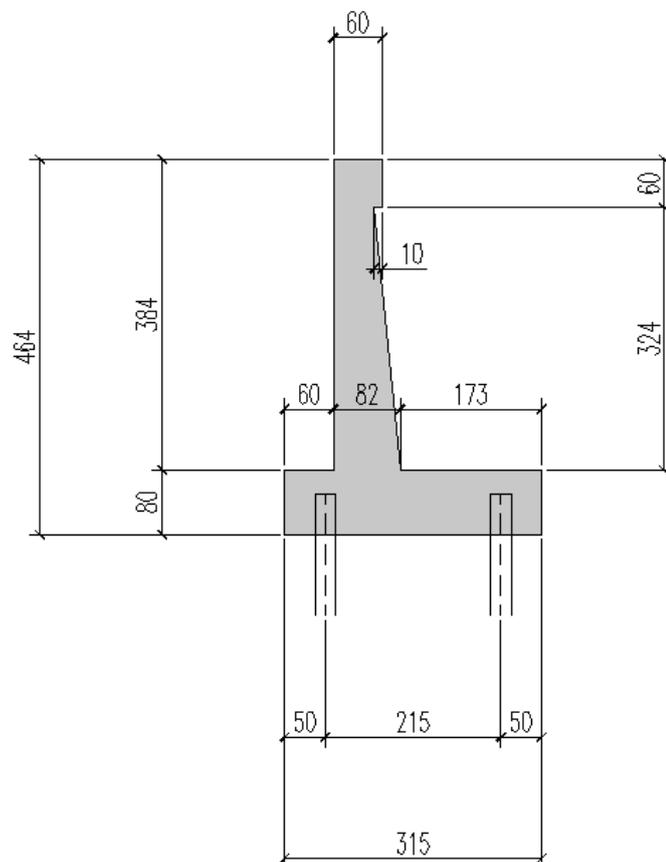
Carpenteria Sezione ad altezza maggiore del Muro M03
